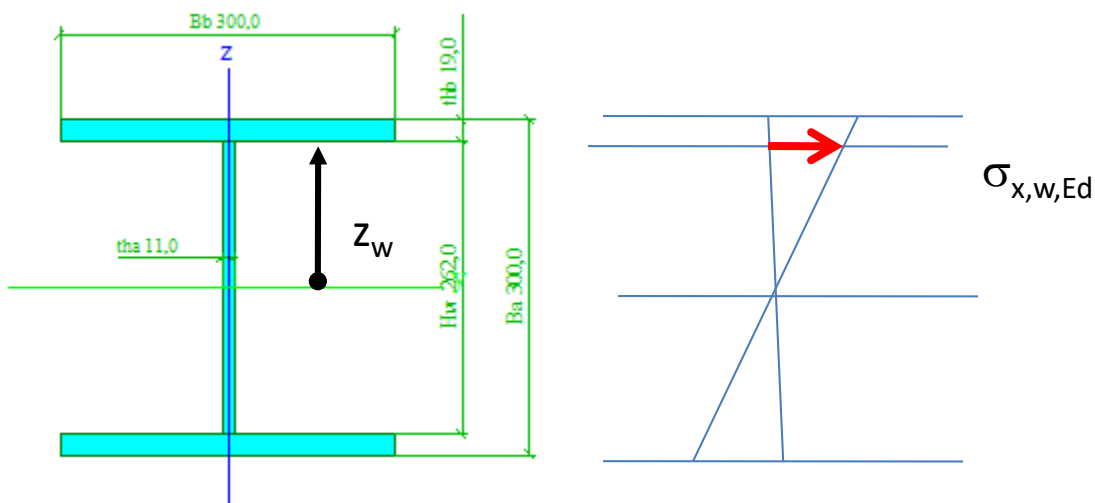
Ausführung der oberen Halsnaht beim I-Schweißprofil
